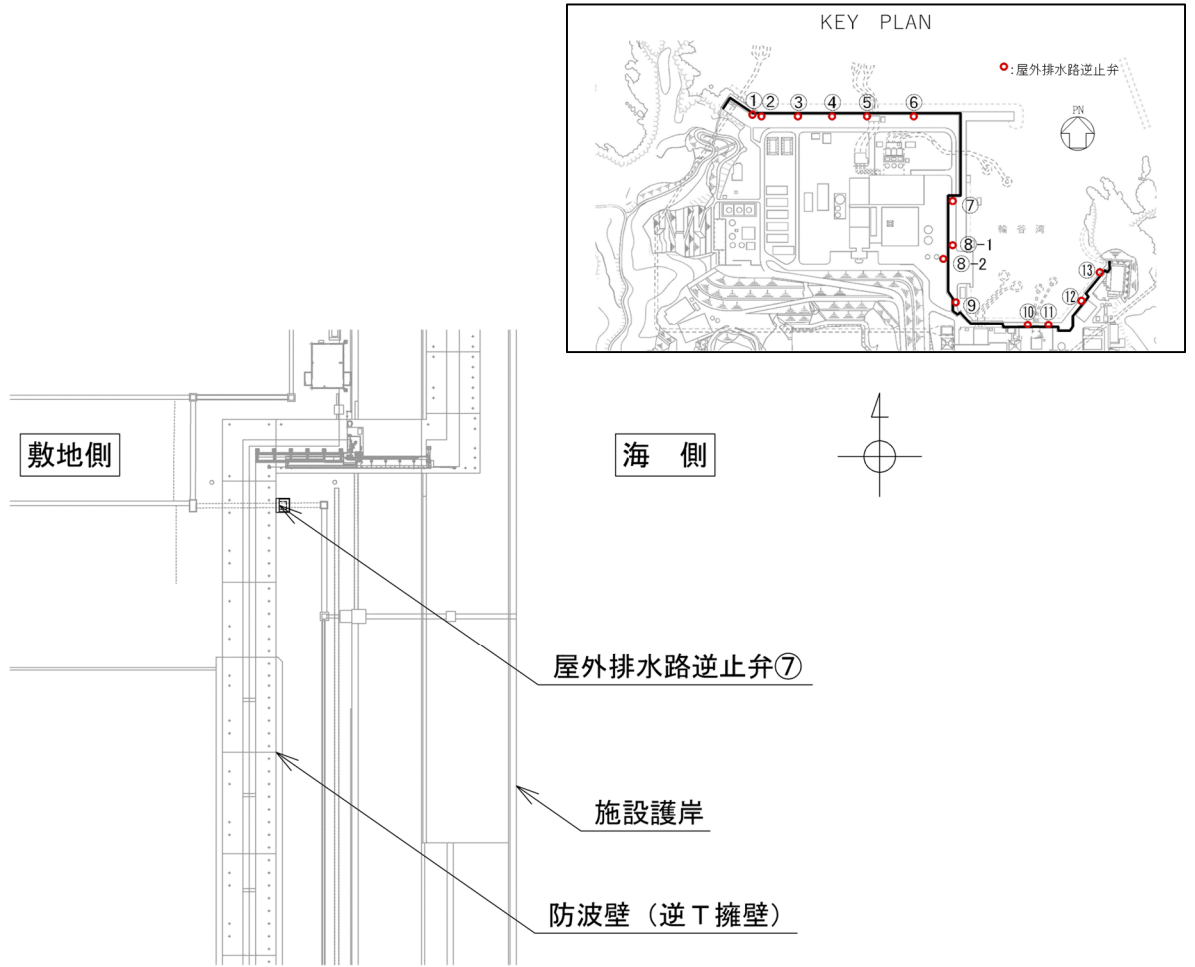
(1) 屋外排水路逆止弁⑦平面图
